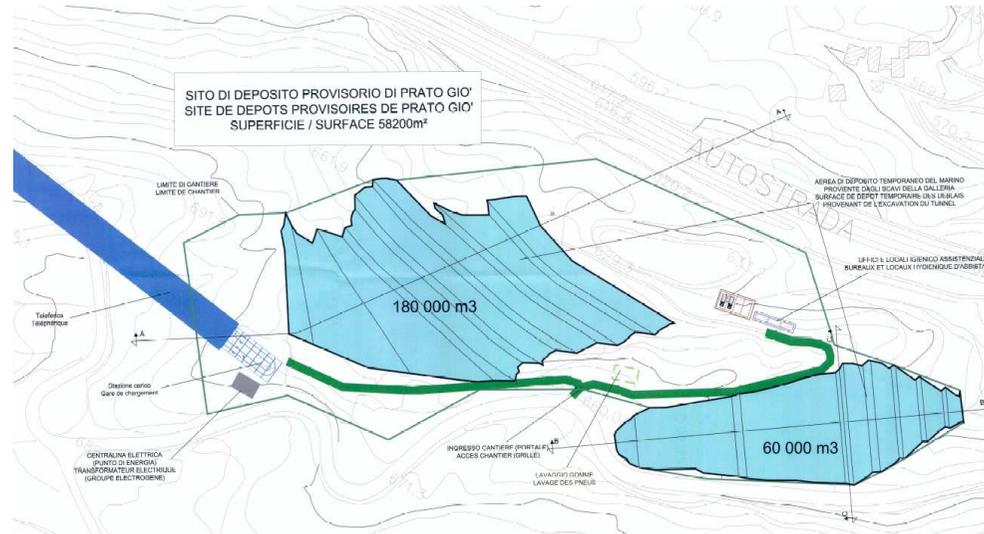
Ex cantiere Prato Giò e collegamento teleferica
